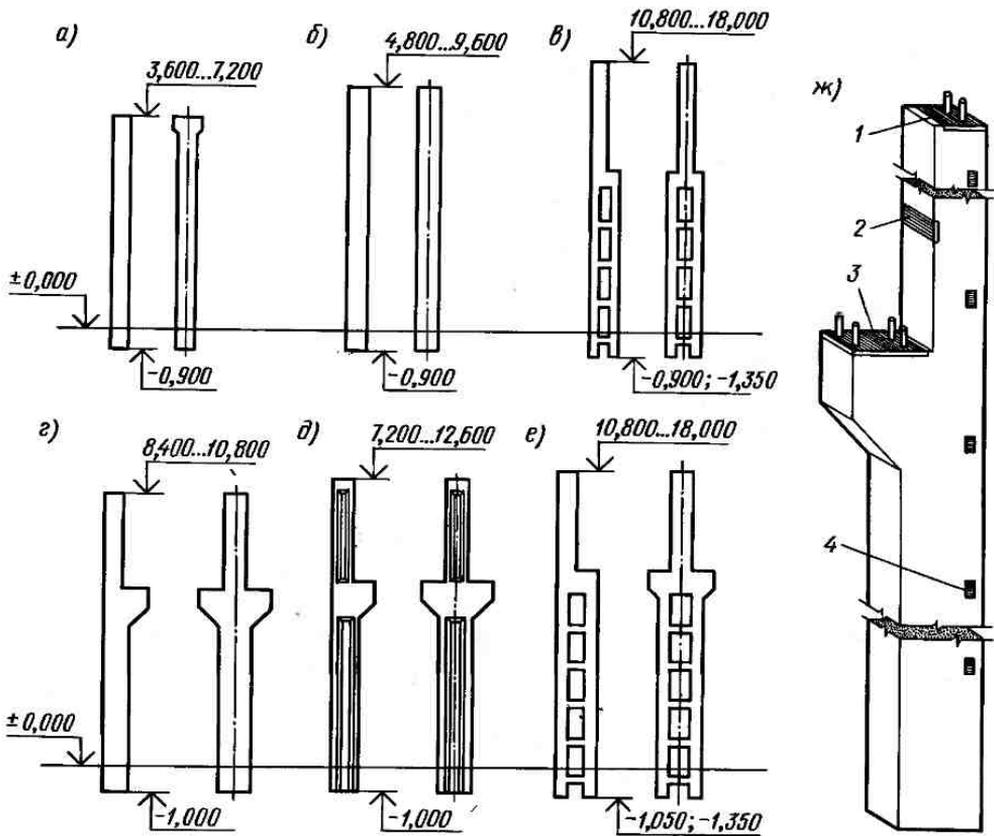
Основные типы железобетонных колонн одноэтажных промышленных зданий: а — прямоугольного сечения для зданий без мостовых кранов при шаге 6 м, б — то же, при шаге 12 м, в — двухветвье для зданий без мостовых кранов, г — прямоугольного сечения для зданий с мостовыми кранами, д — то же, двутаврового сечения, е — двухветвье для зданий с мостовыми кранами, ж — общий вид колонны, 1 — закладная деталь для крепления несущей конструкции покрытия, 2, 3 — то же, подкрановой балки, 4 — то же, стеновых панелей
